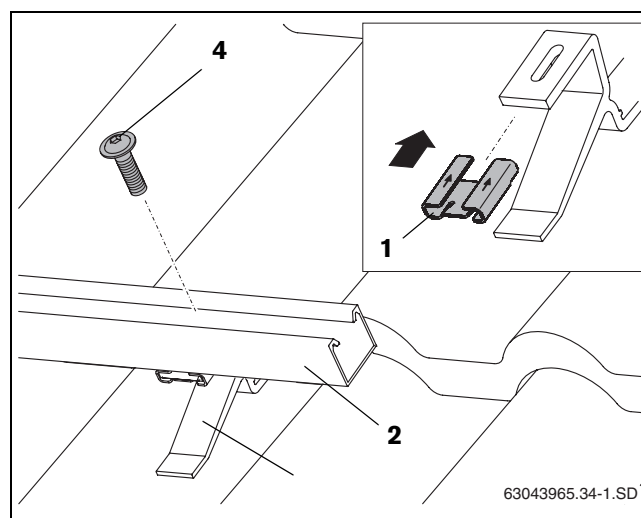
Fijación de los perfiles guía a los ganchos de tejado
